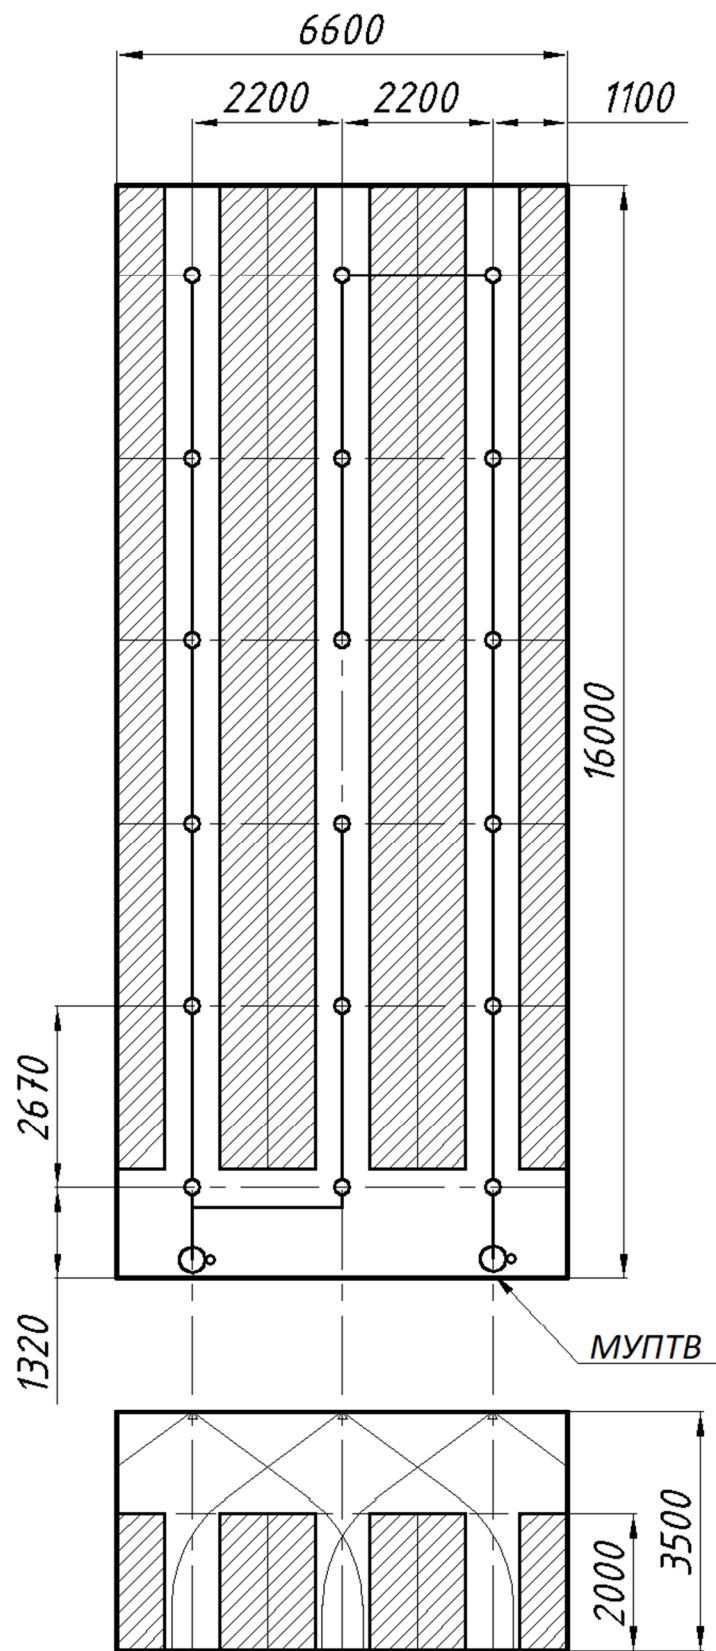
Вариант размещения МУПТВ-160-Г-ВД с насадками-распылителями «НС-145» на плане защищаемого помещения.
